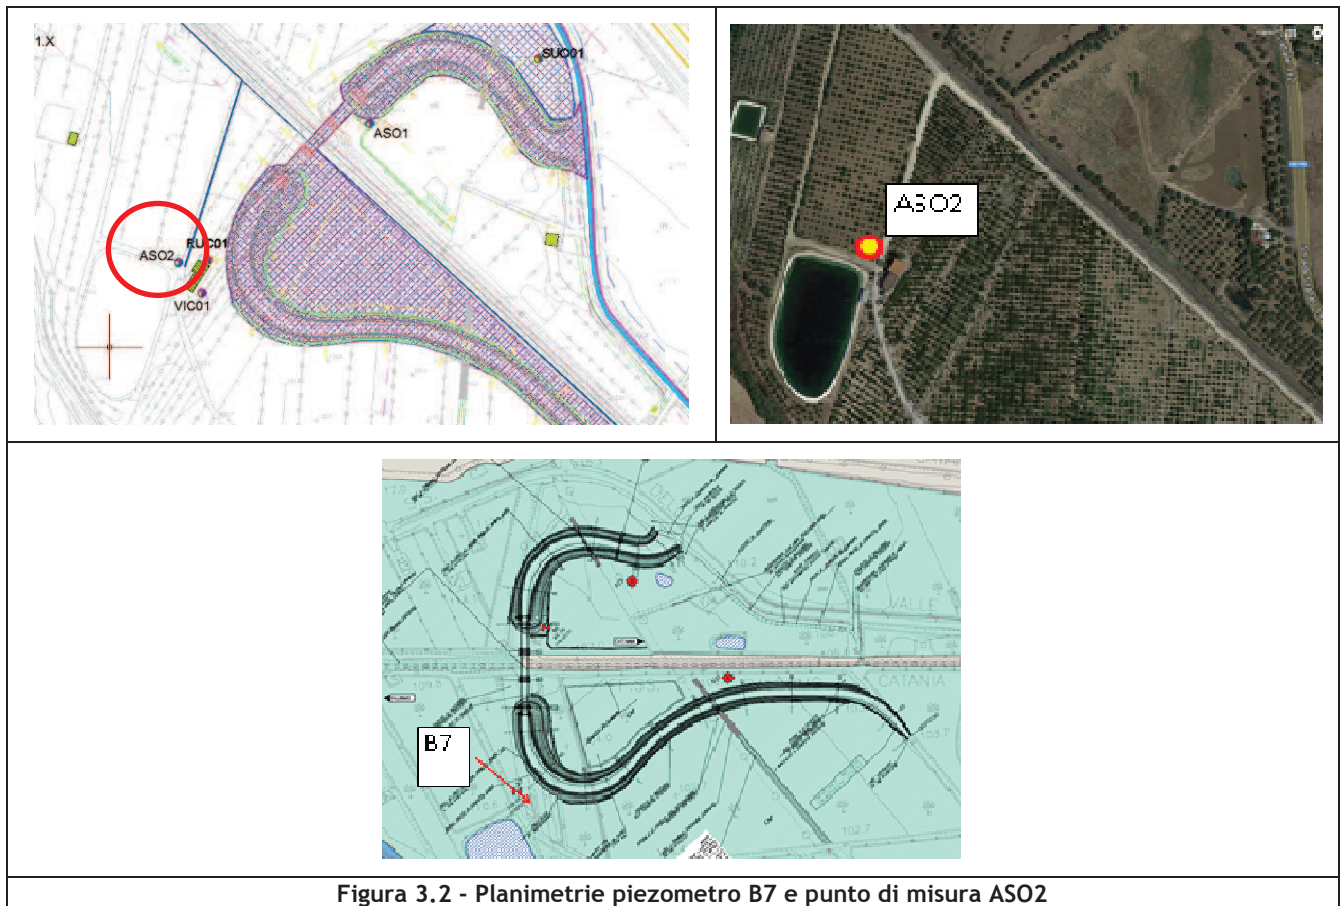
Planimetrie piezometro B7 e punto di misura ASO2
